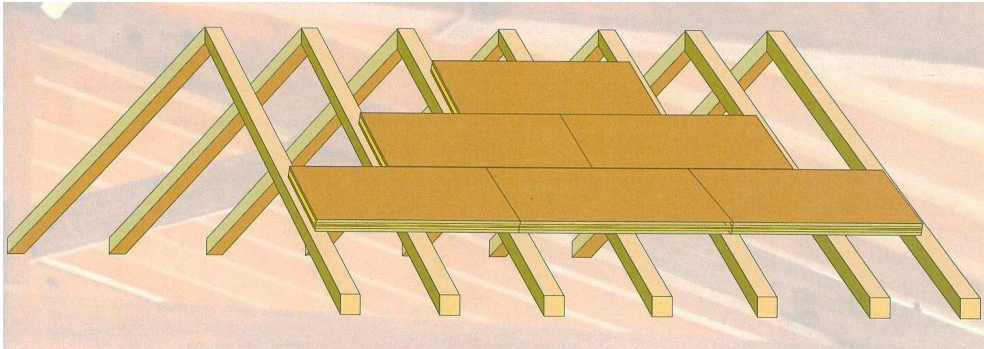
Ejemplo de una de las posibles disposiciones del panel en la cubierta
